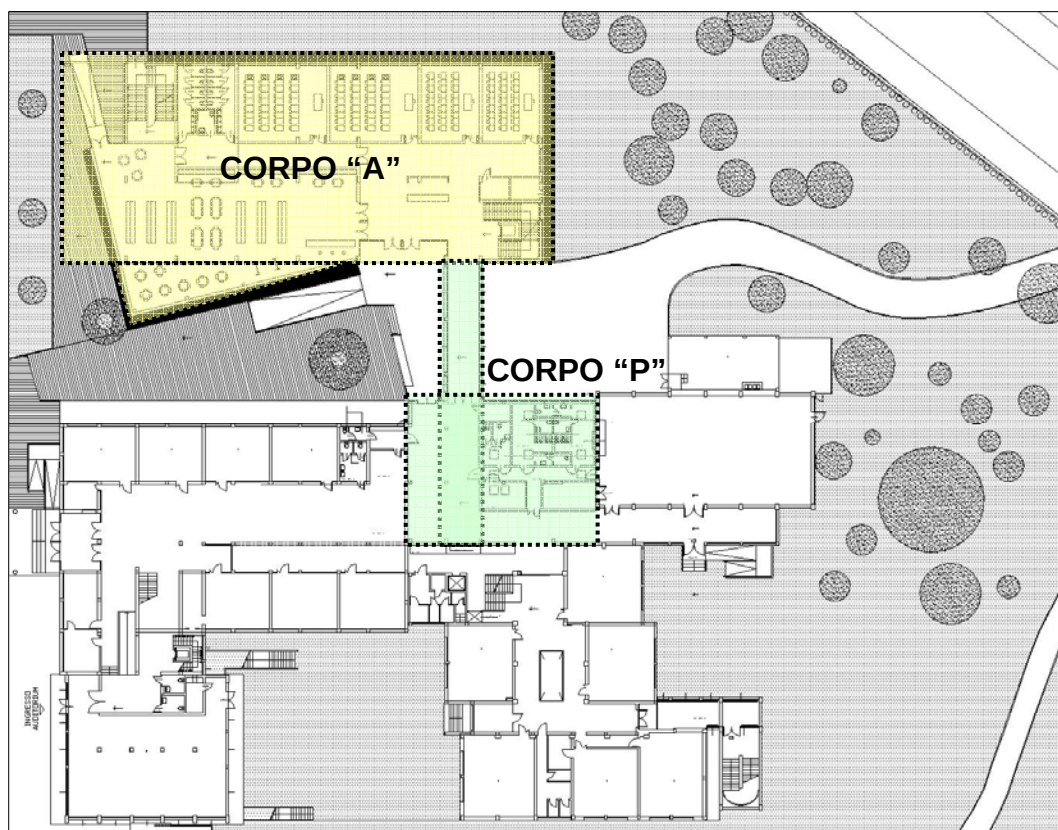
Planimetria di inquadramento dell'area di intervento
